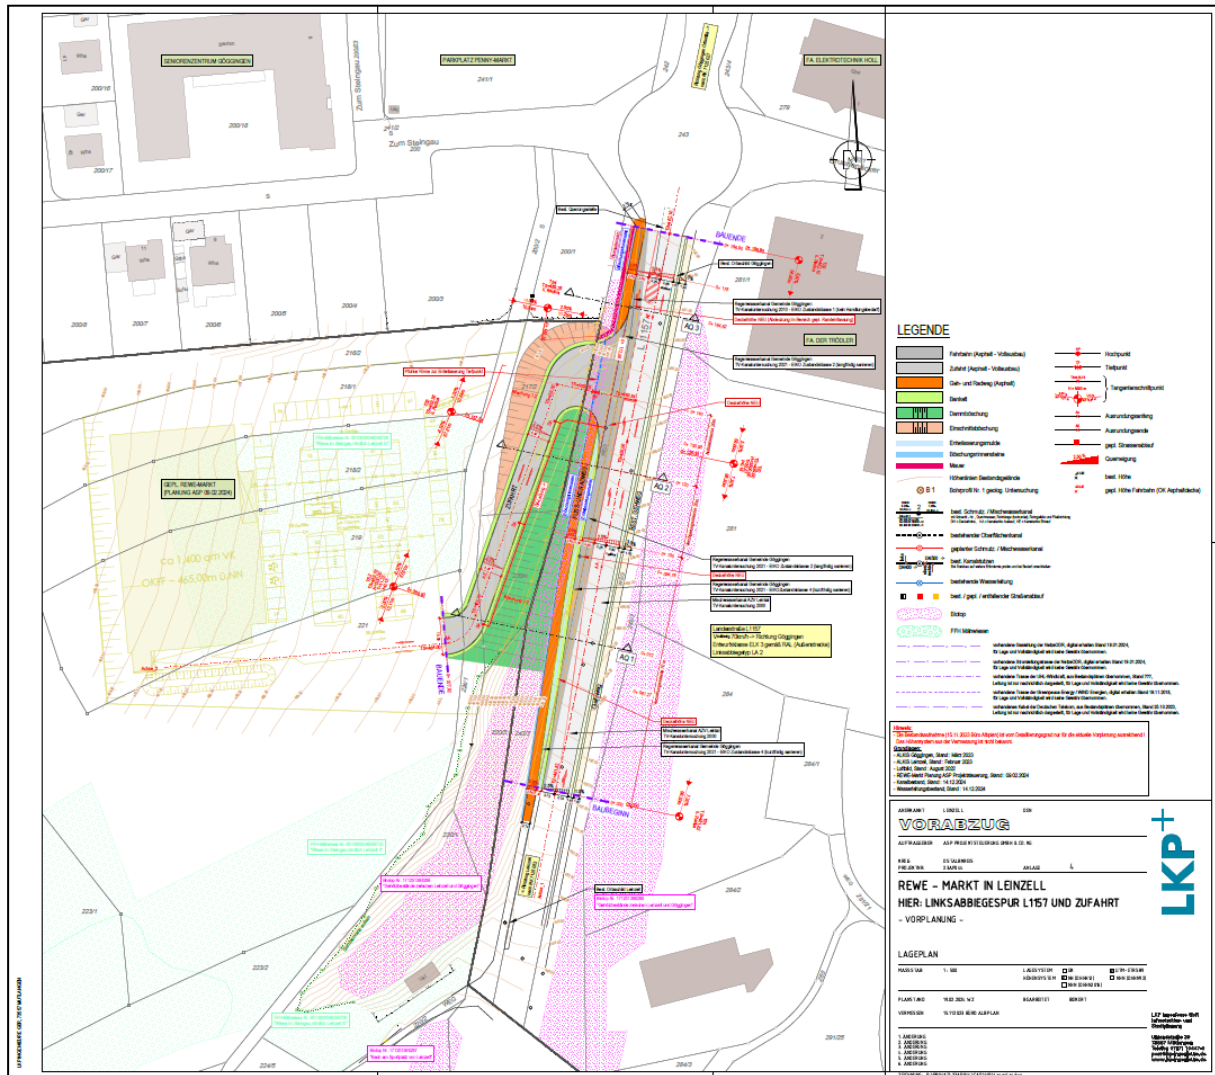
Vorabzug zum Lageplan des Bebauungsplans „REWE-Markt“, Gemeinde Leinzell.
